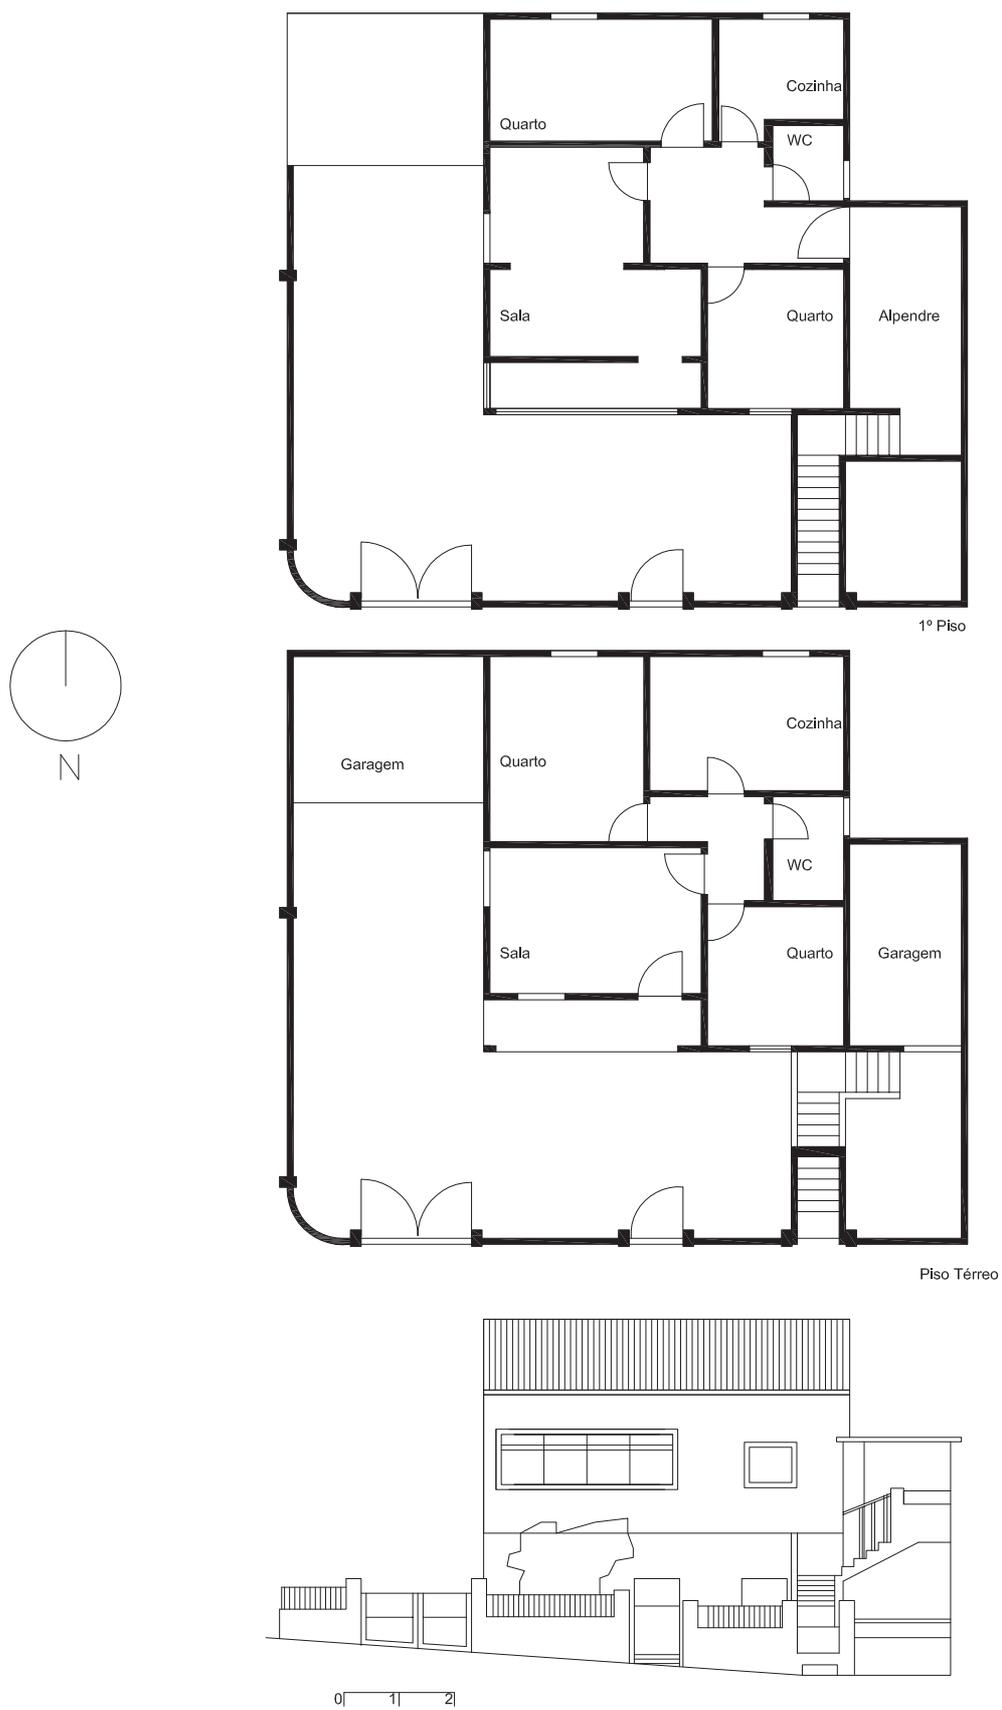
| Planta de piso térreo, planta de 1º piso e Alçado Sul
